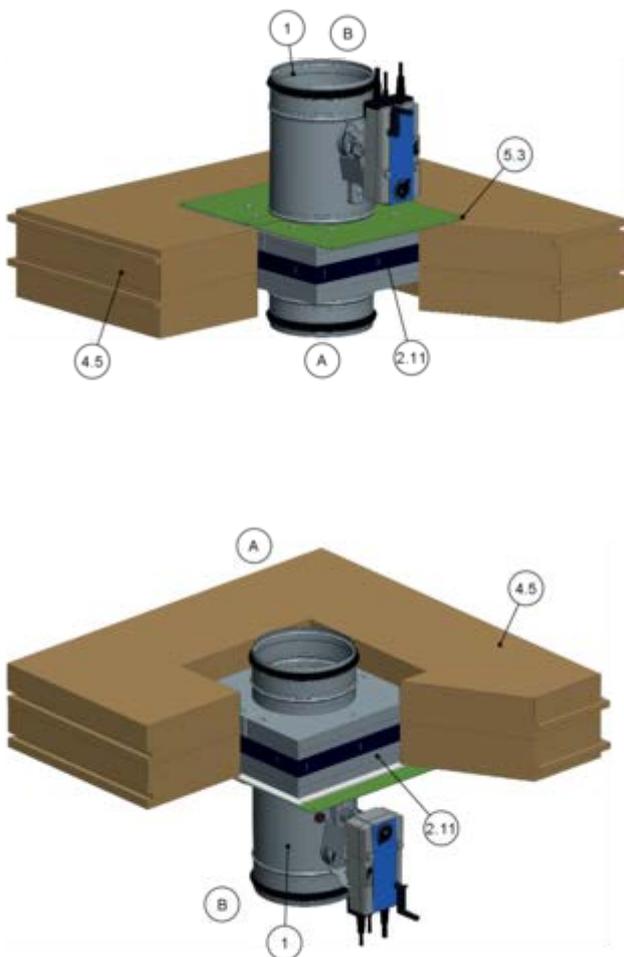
Montage à base de mortier dans une dalle en bois pleine, suspendu ou à la verticale
